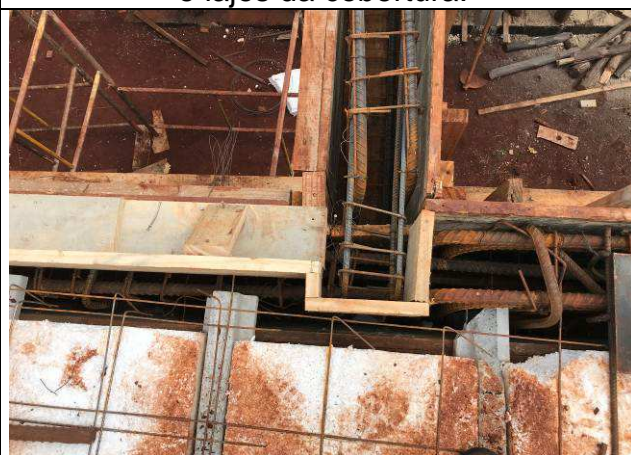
C: Formas e armaduras das vigas e lajes da cobertura - junta de dilatação.
